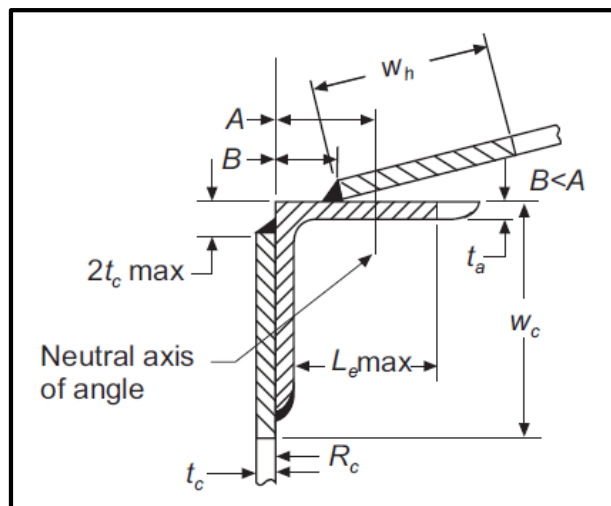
Detalles permisibles de la junta al ángulo superior
